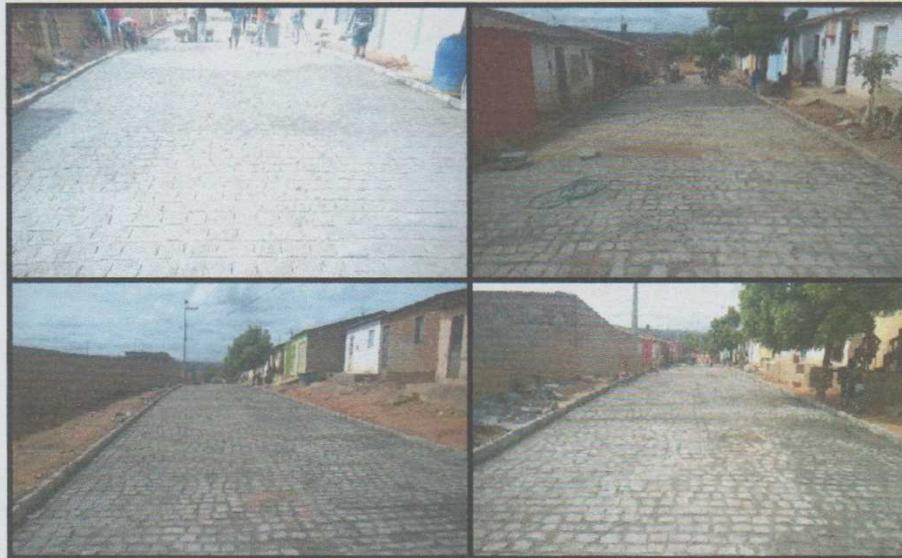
Assentamento do pavimento e aplicação de gorda de cimento
